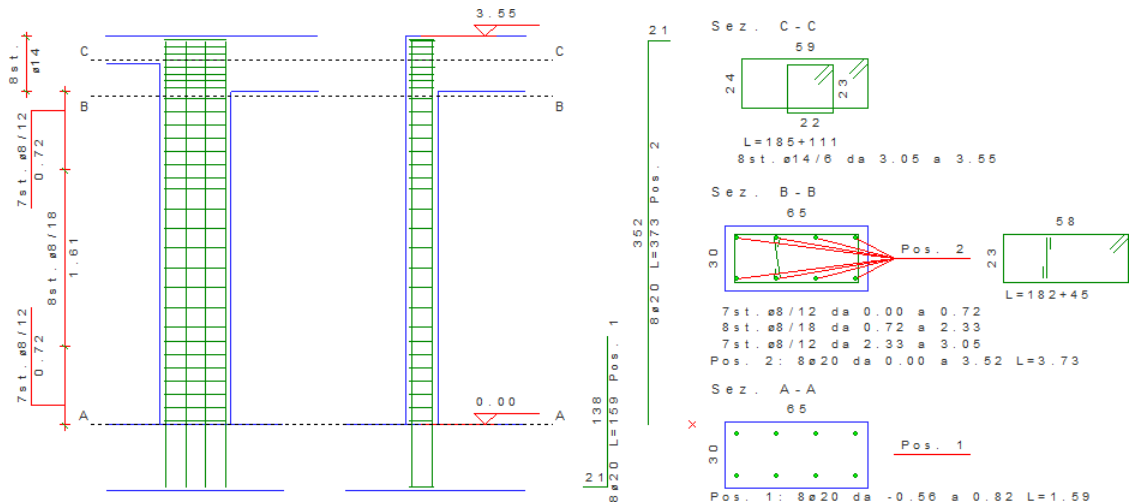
PILASTRO N. 1, 6, 7, 12
